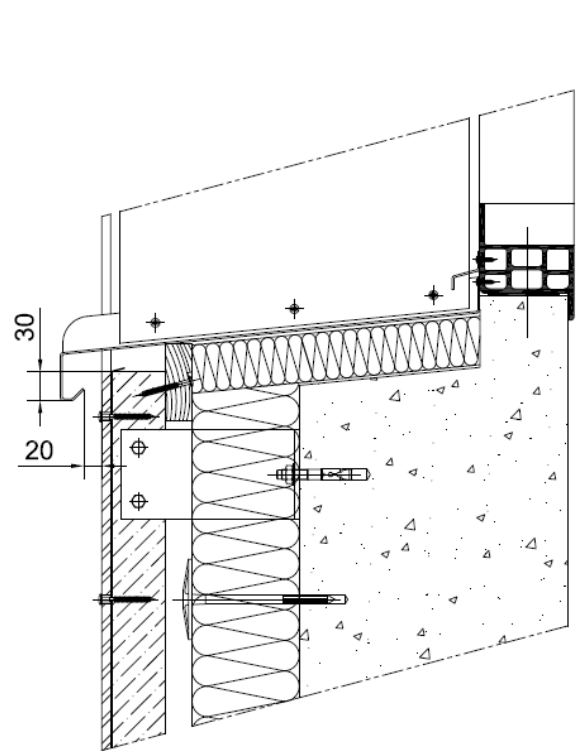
Sección vertical. Detalle de vierteaguas.
